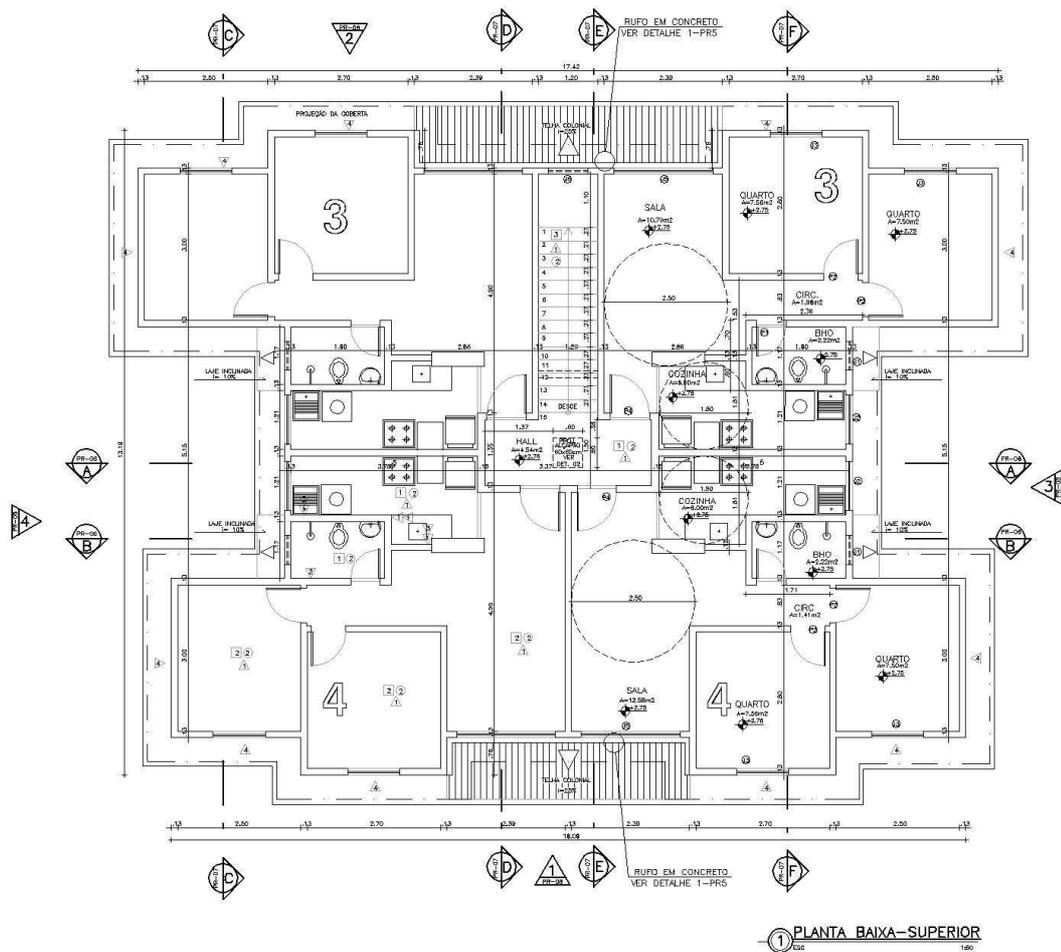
Planta Baixa do Bloco de Apartamento – Superior – Projeto Padrão (ARQUITETO PEDRO RICARDO S. BEZERRA, 2004).
